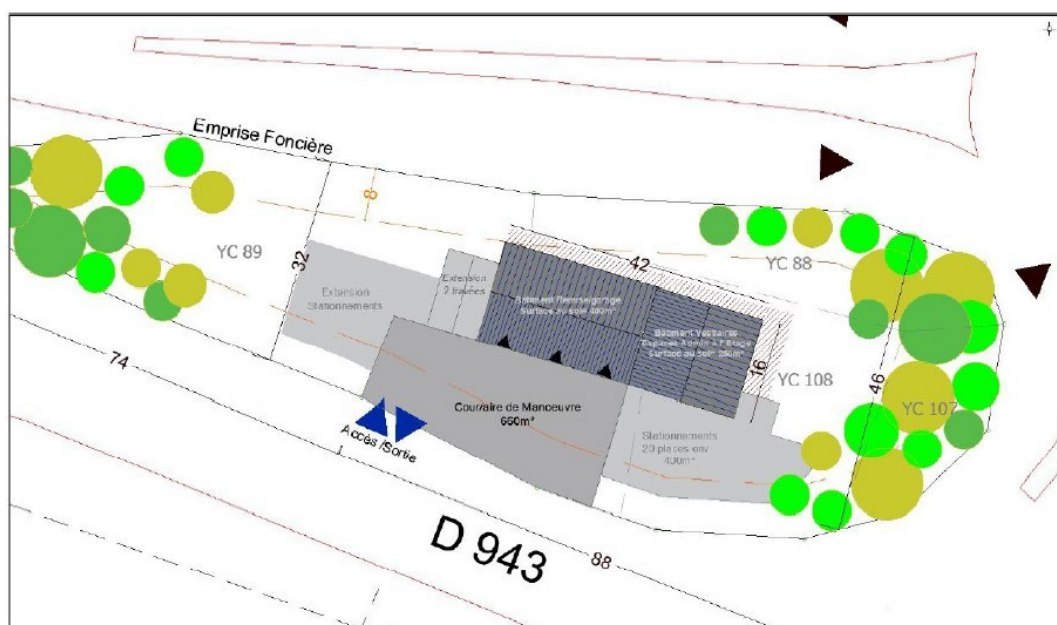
Plan d'implantation du projet (source : rapport de présentation)
